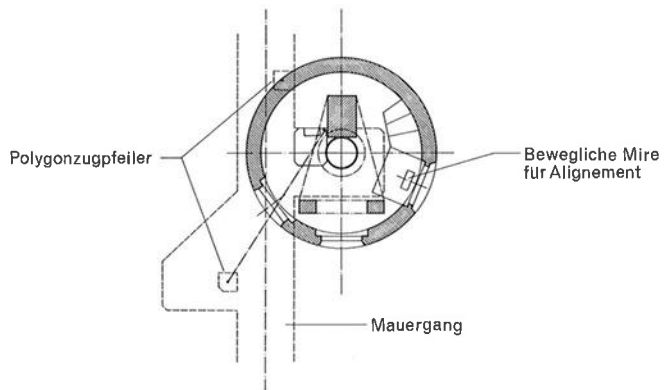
Meßbunker auf der Krone des Künstlichen Widerlagers – Grundriß
